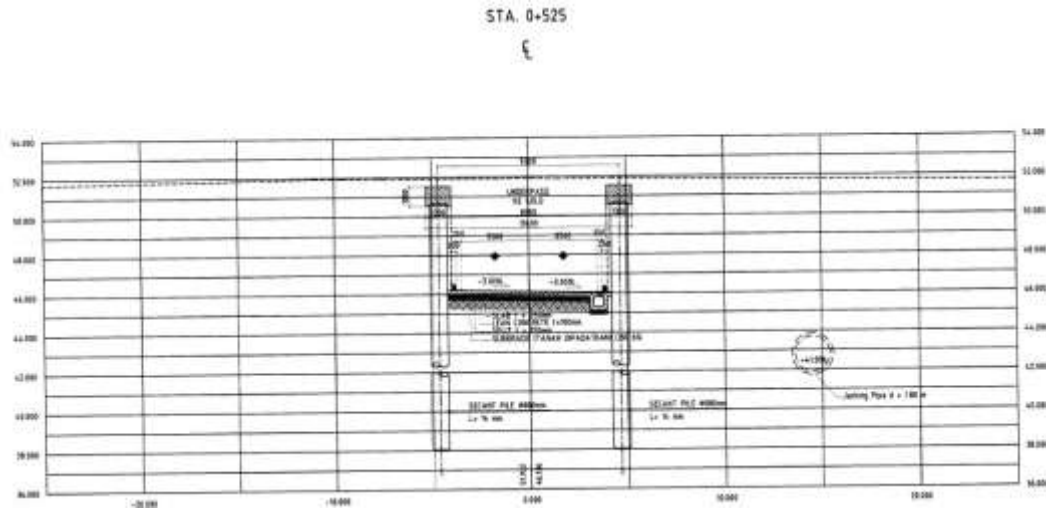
Rencana Detail Underpass Tampak Atas
